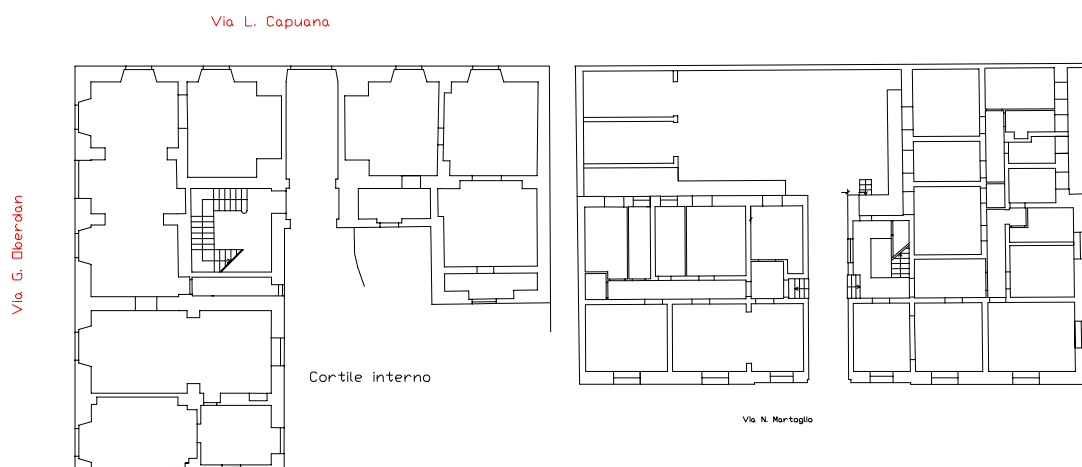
Edificio CA1 - Pianta del piano terreno.
